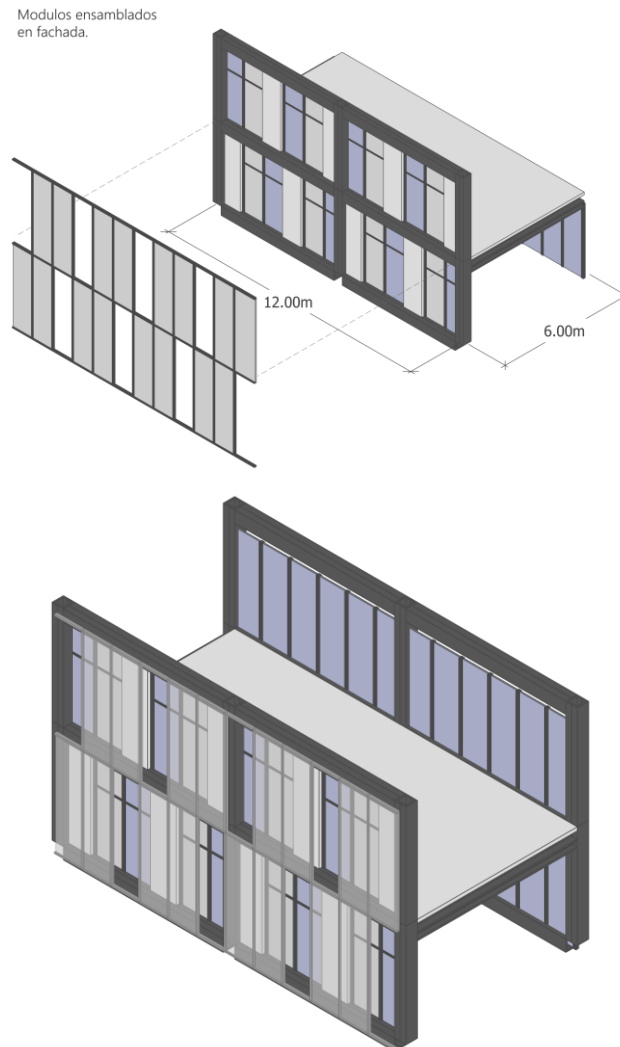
Módulos ensamblados en fachada. Crujía estructural de 6m.
